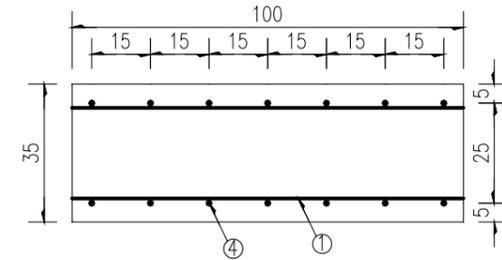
护栏断面 2-2 计算简图（尺寸单位：cm）
